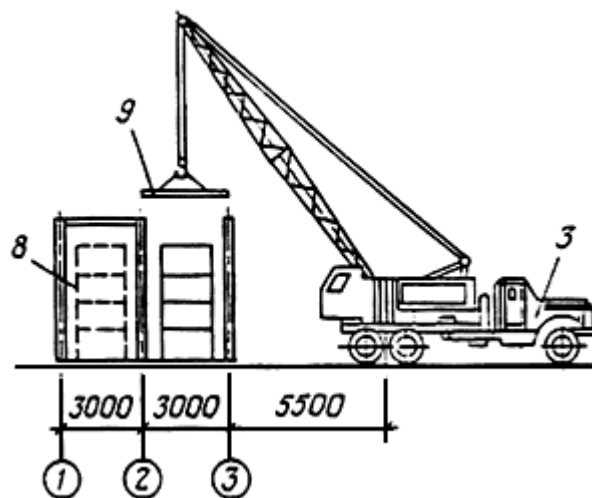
Схема организации строительной площадки (вариант I), монтаж распорок
